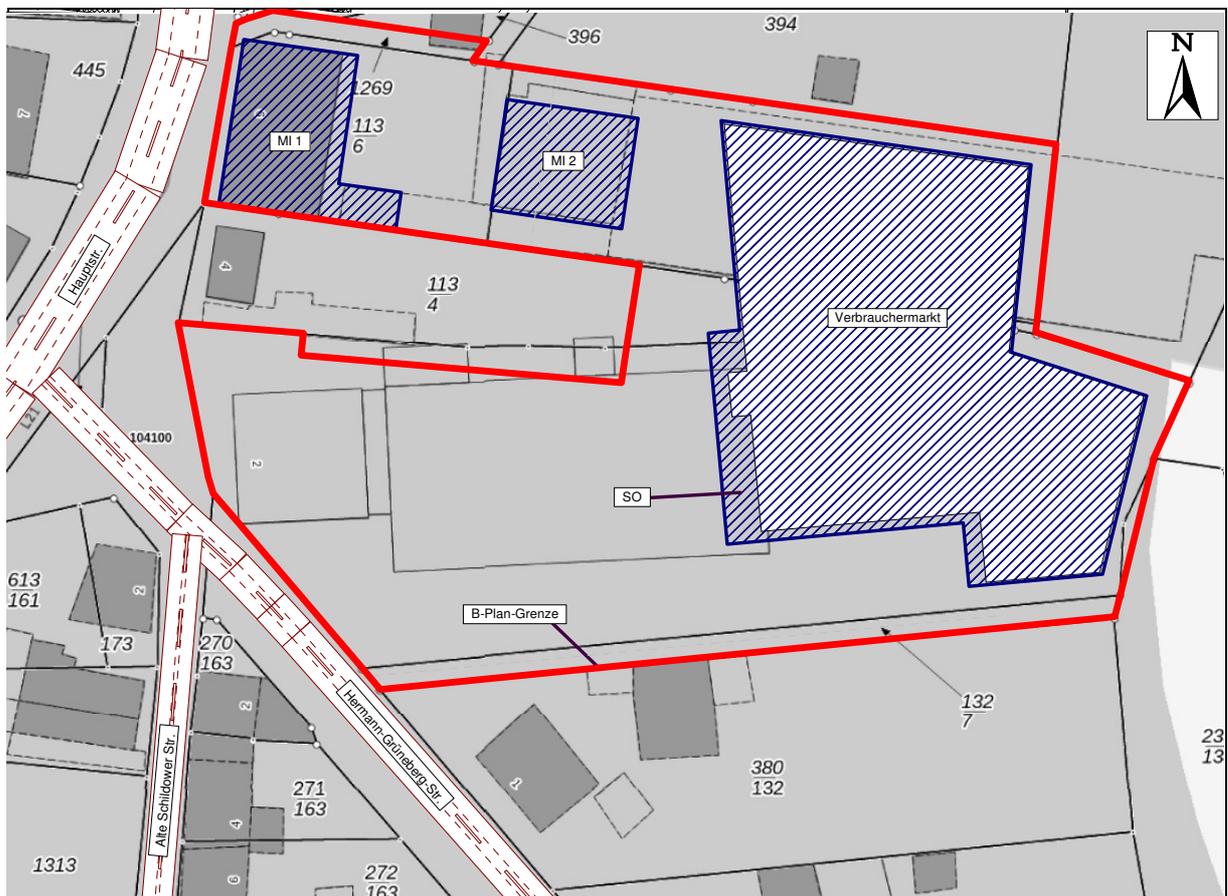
Lageplan des B-Plan-Gebiets in der Umgebung
